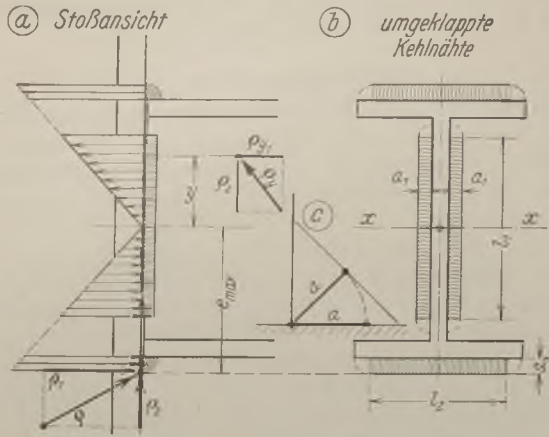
Berechnung eines Schweißanschlusses für eine Auflagerkraft  $A$  und für ein Moment  $M$ .
